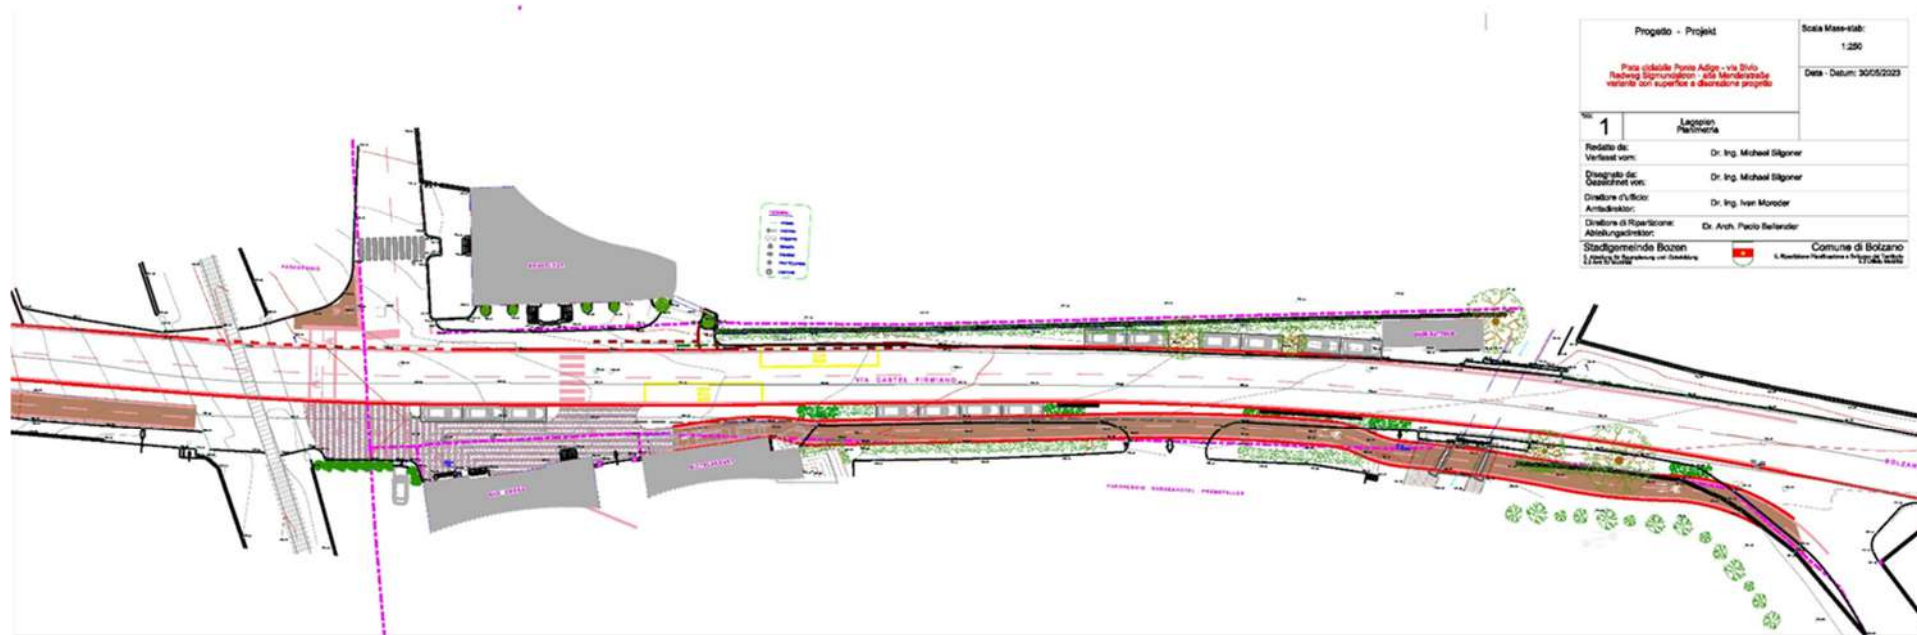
Ciclabile ponte Adige e Castel Firmiano (7) - Planimetria di progetto
